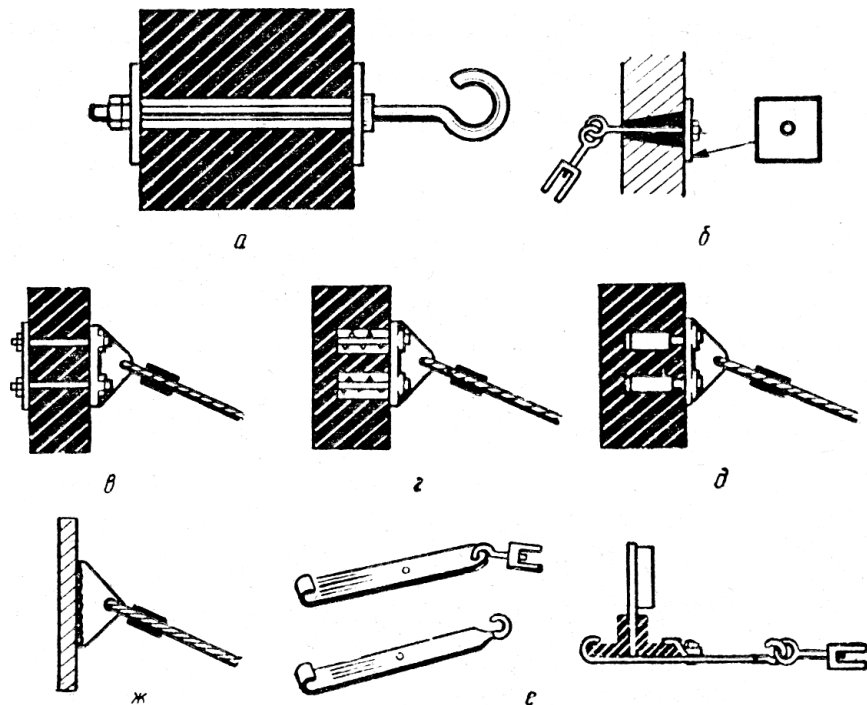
Способы крепления анкерных крепежных конструкций и способы их установки: *а* — натяжной болт с крюком; *б* — то же но с кольцом; *в* — анкер закрепленный шпильками; *г*—*д* — натяжной анкер закрепленный в бетоне распорными анкерами; *ж* — крепление сваркой; *е* — конструкции для крепления к металлическим фермам
